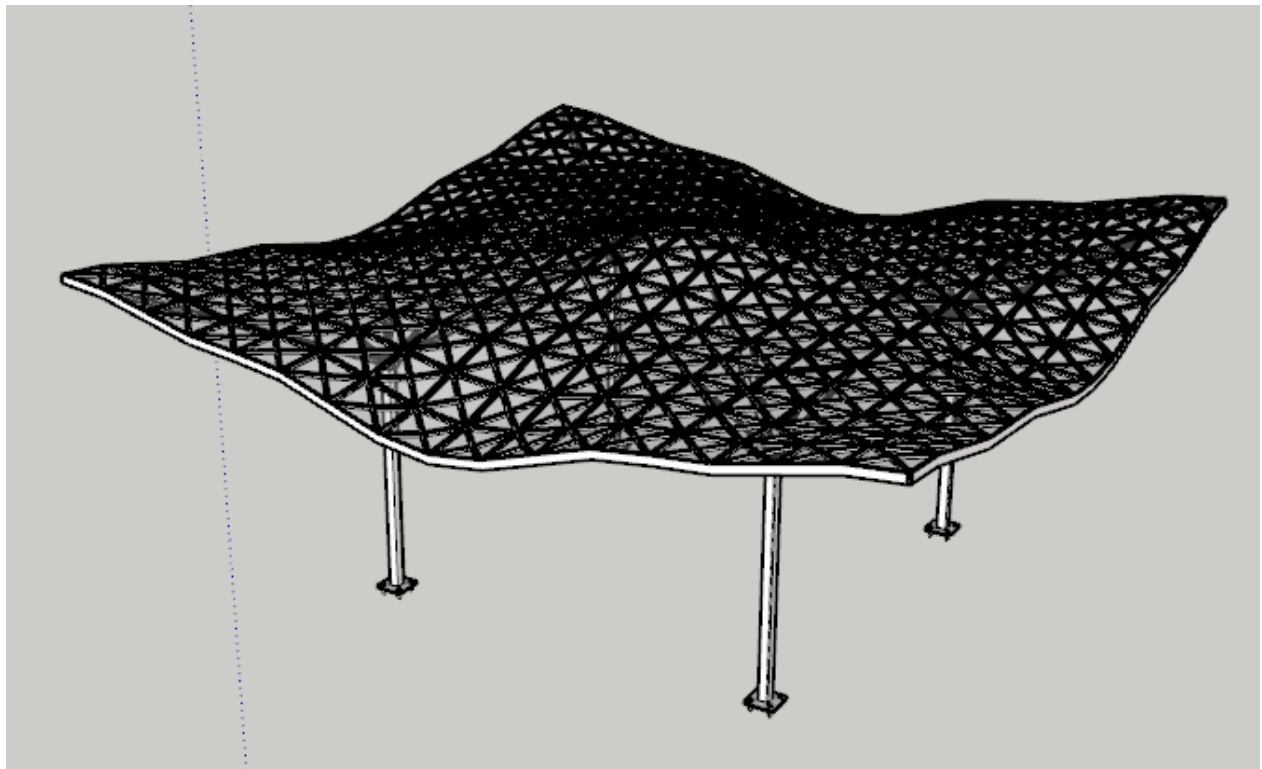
Planimetría y modelado 3d de propuesta 3 de paneles solares
